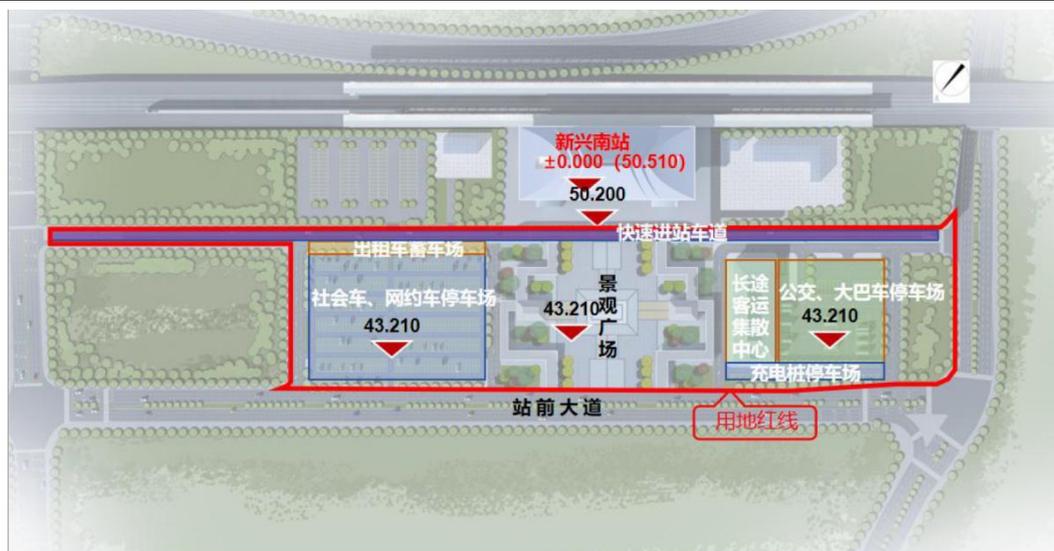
广湛高铁新兴南站站前广场周边交通设施布局平面图
